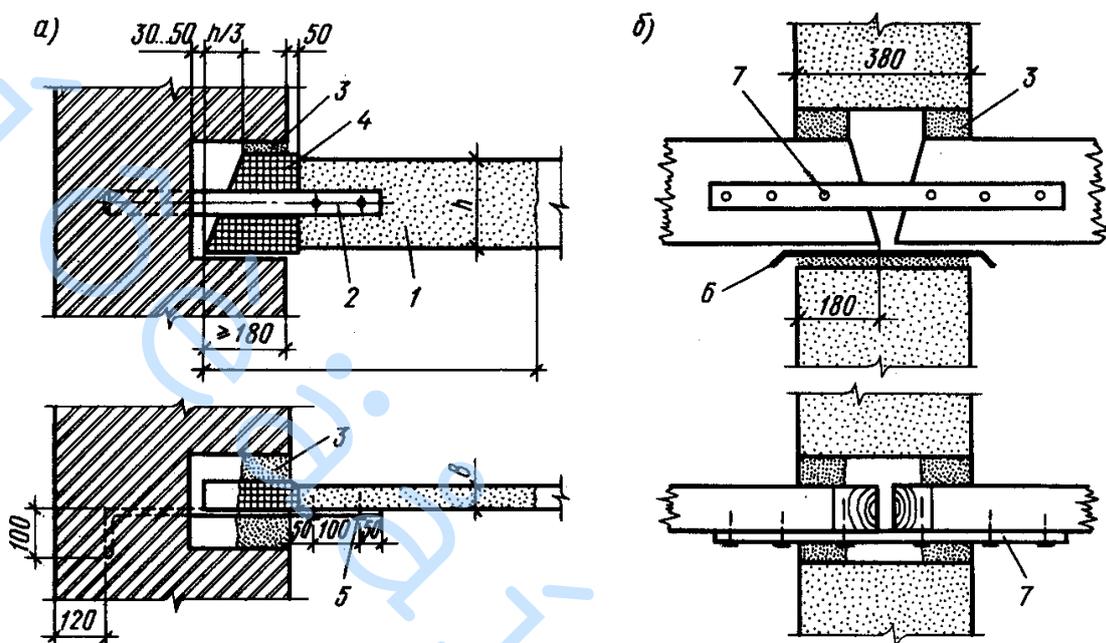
Опираие деревянных балок на каменные стены с глухой заделкой:
